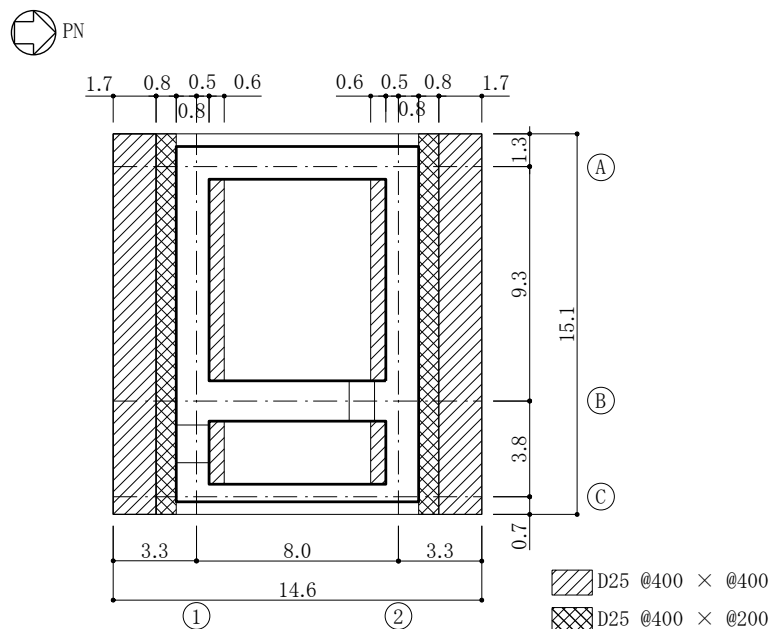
基礎スラブの配筋領域図 (せん断補強筋) (単位 : m)
